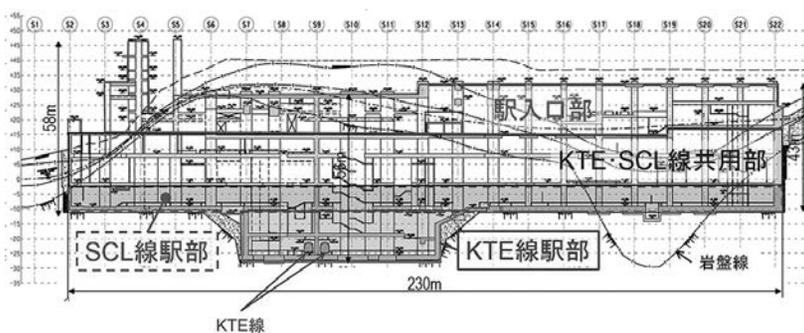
何文田駅舎 KTE線断面図 (SCL線縦断面図)
